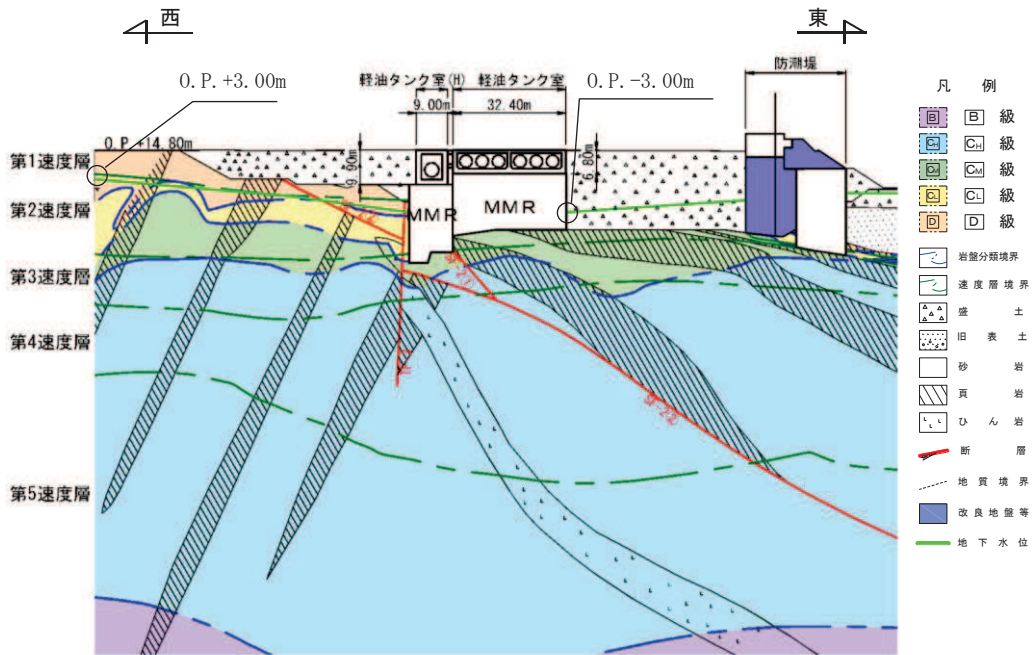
軽油タンク室 地震時荷重算出用地質断面図
